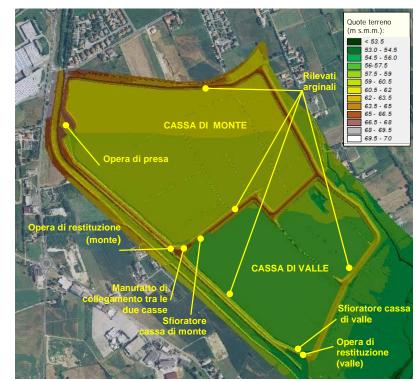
Modello digitale del terreno dell'intervento con indicazione delle opere principali.
